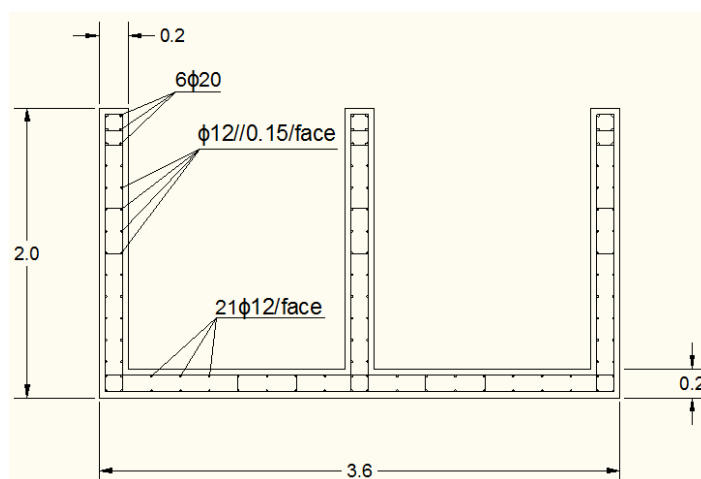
Disposição de armaduras - Caixa de elevadores
